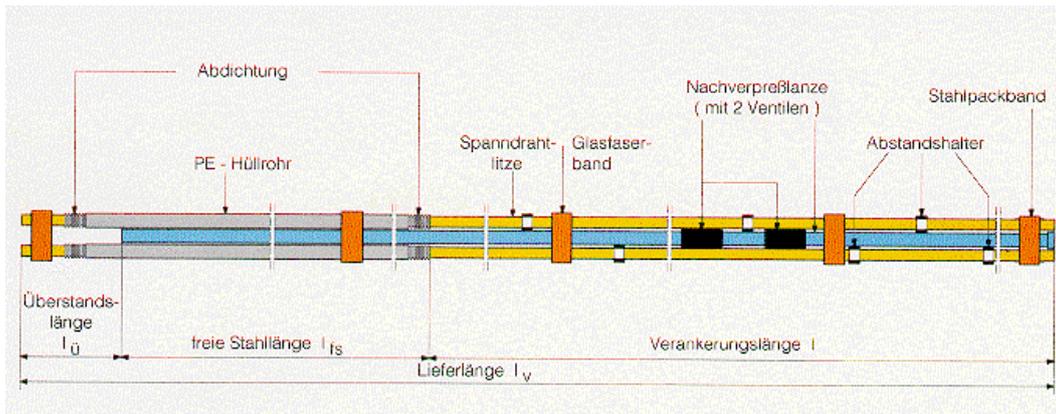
Temporärer Litzenanker, Ankerzugglied mit Nachverpresslanze [2]
